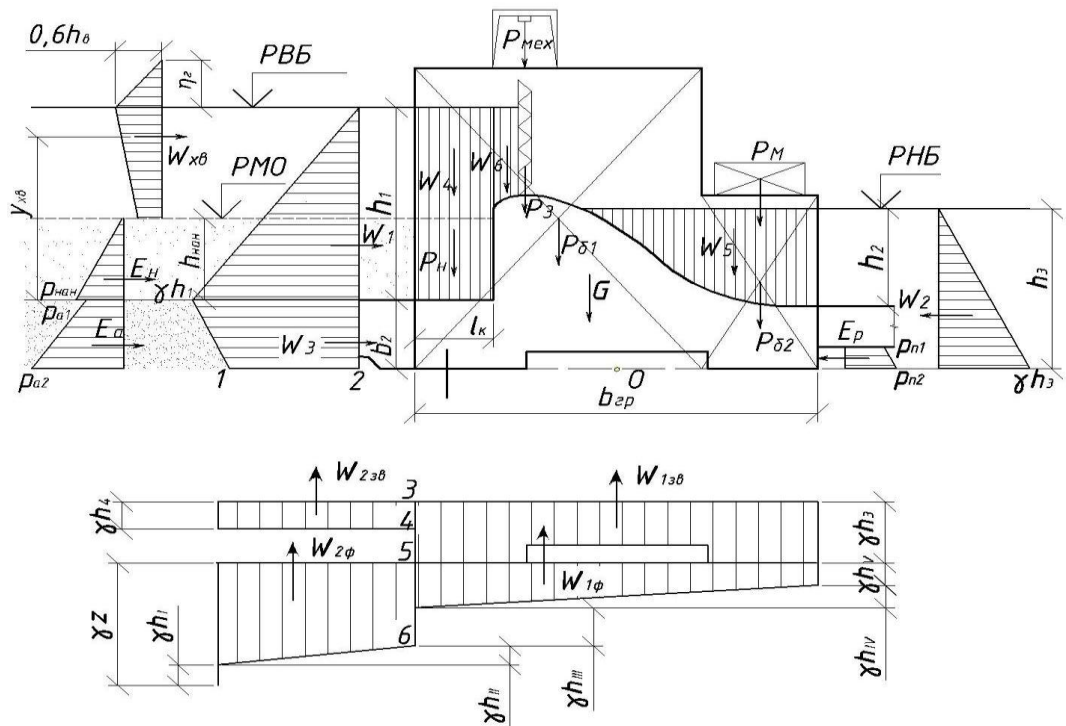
Схема силових дій на греблю з ґрунтовим понуром
